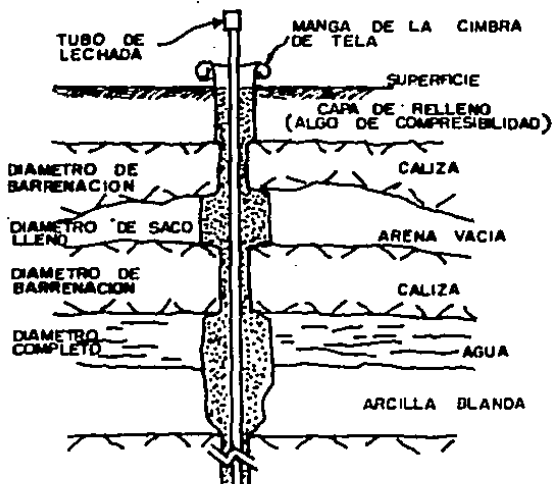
USO DEL GEOTEXTIL COMO CIMBRA DE COLUMNA
